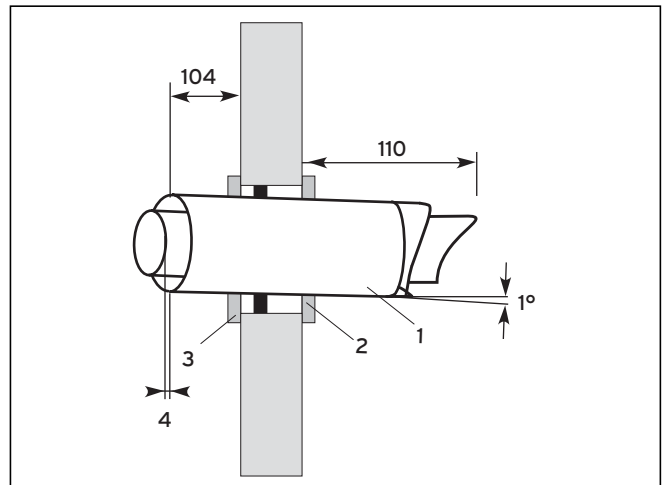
Montaggio del passante a parete (installazioni dirette)
